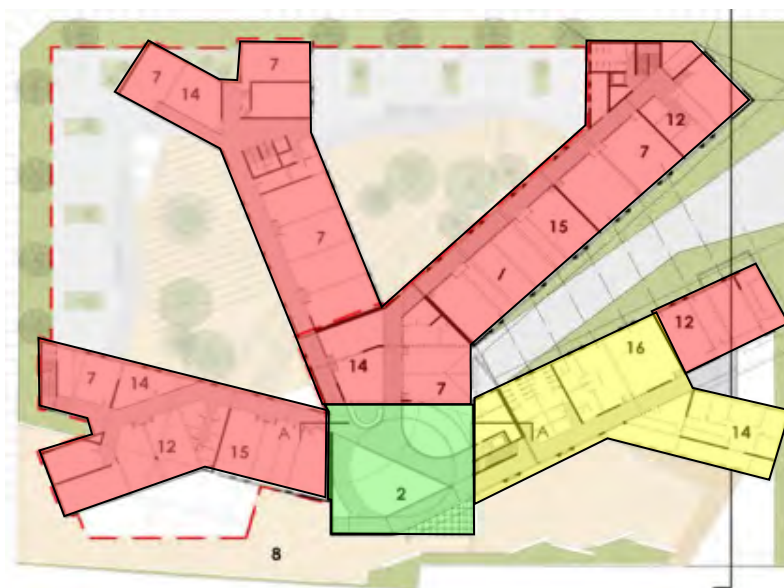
Tercera Planta del Instituto Superior Santo Tomás
